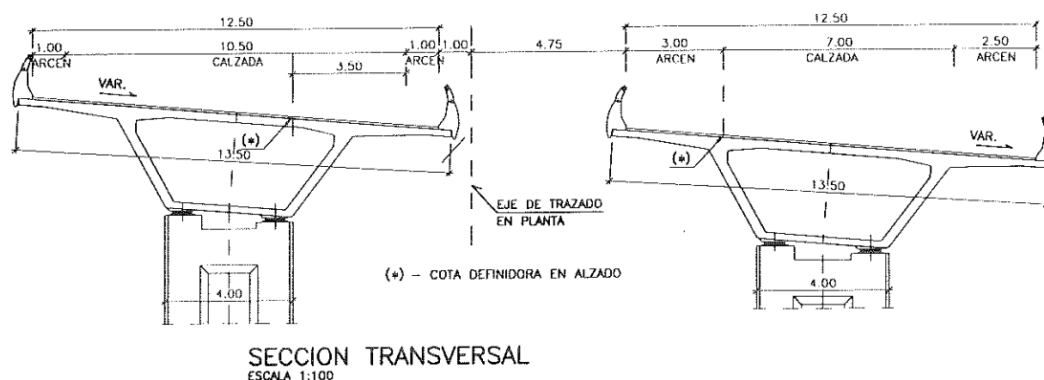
Sección tipo de las dos calzadas de la estructura. (Fuente: [2]).
